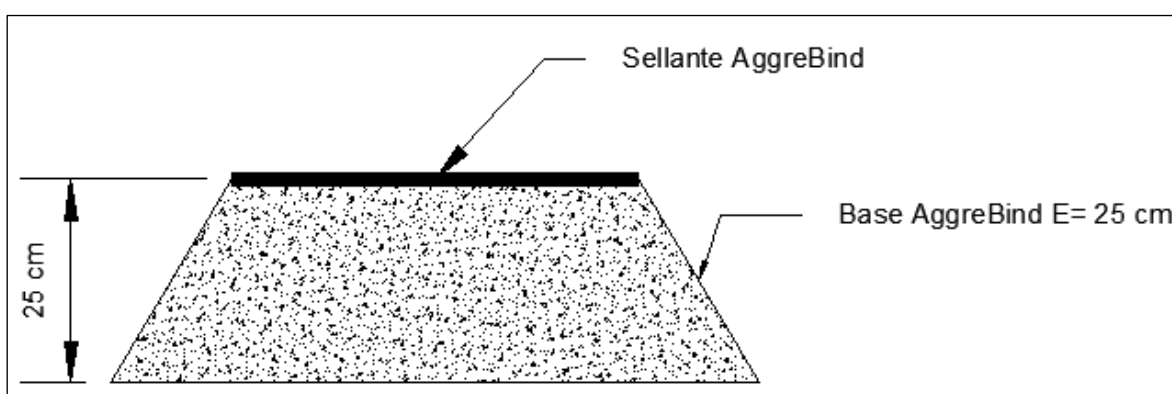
Estructura de pavimentación con AggreBind más Sellante AggreBind
